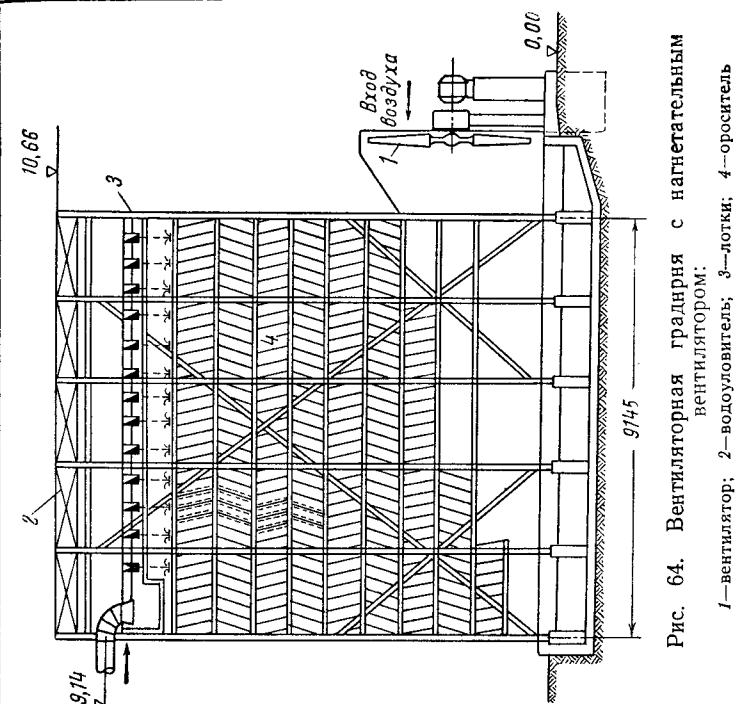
Вентиляторная градирня с нагнетательным вентилятором:
